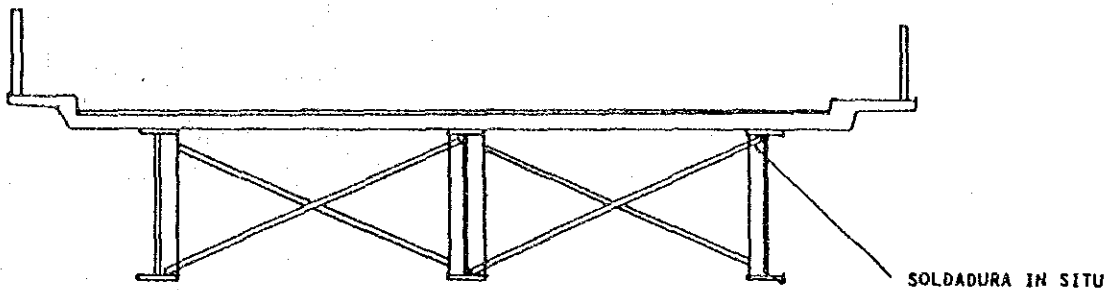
CONSTRUCCIÓN DE TRAVESAÑOS
